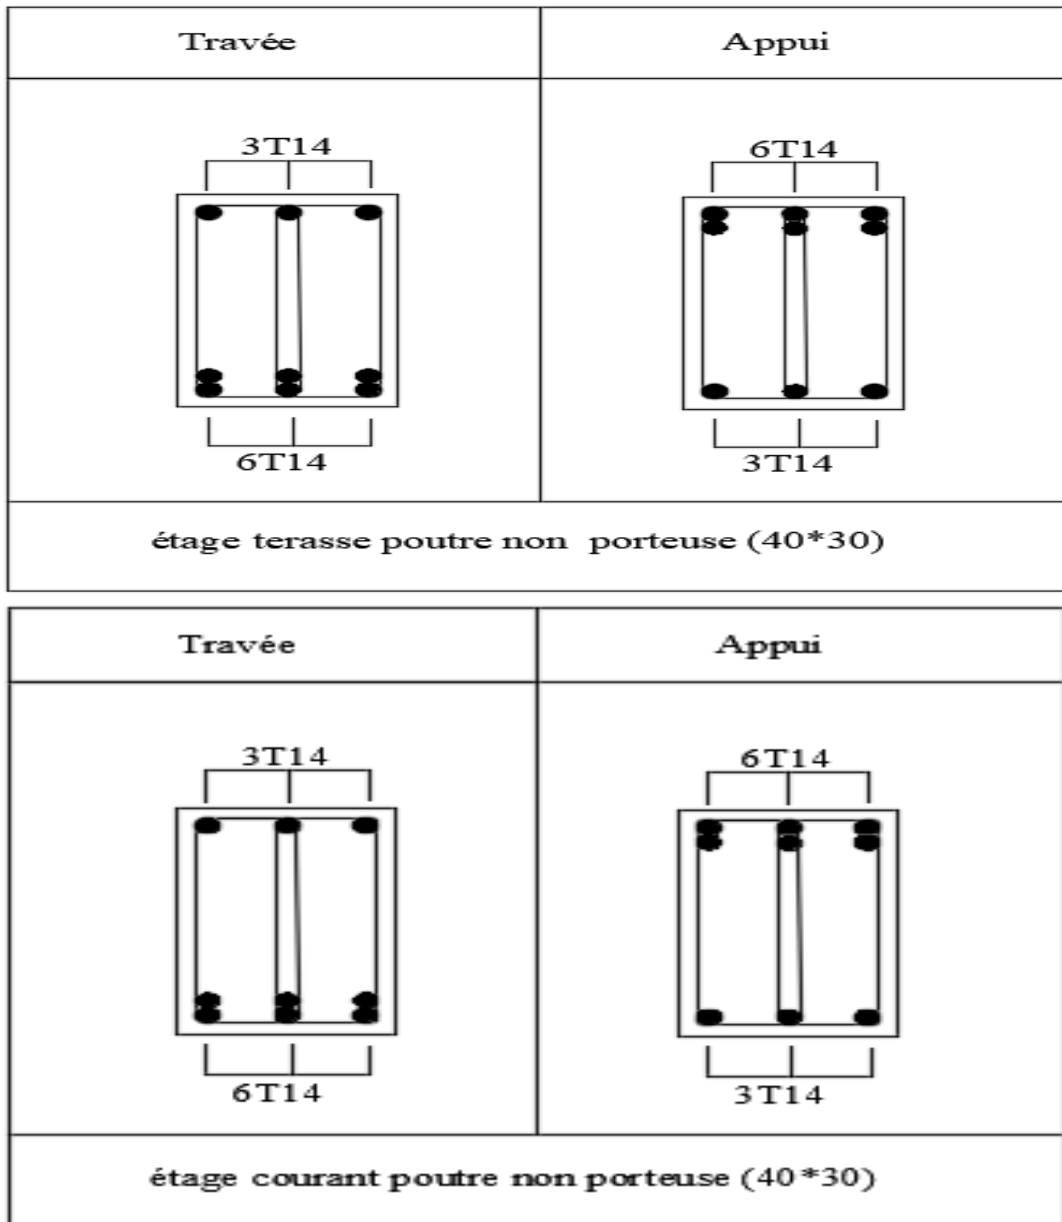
Schéma de ferrailage des poutres non porteuses.
